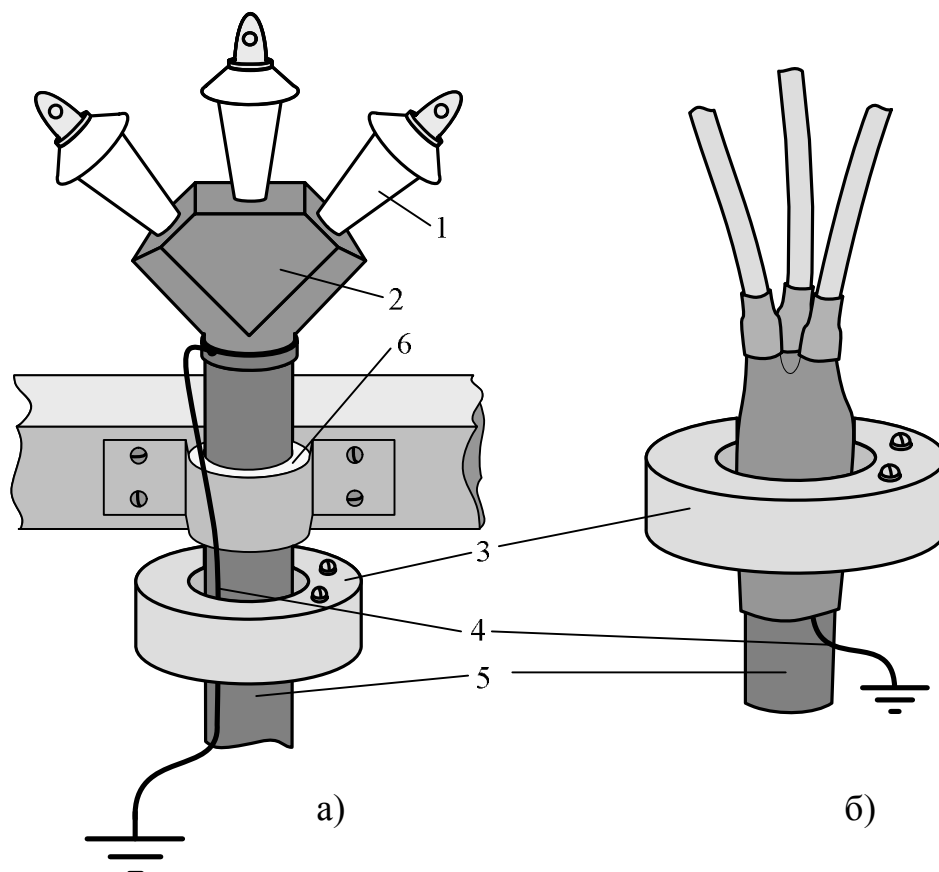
Монтаж заземления оболочки кабеля: 1 – проходной изолятор; 2 – корпус муфты; 3 – ТТП; 4 – провод заземления; 5 – кабель; 6 – изоляция
